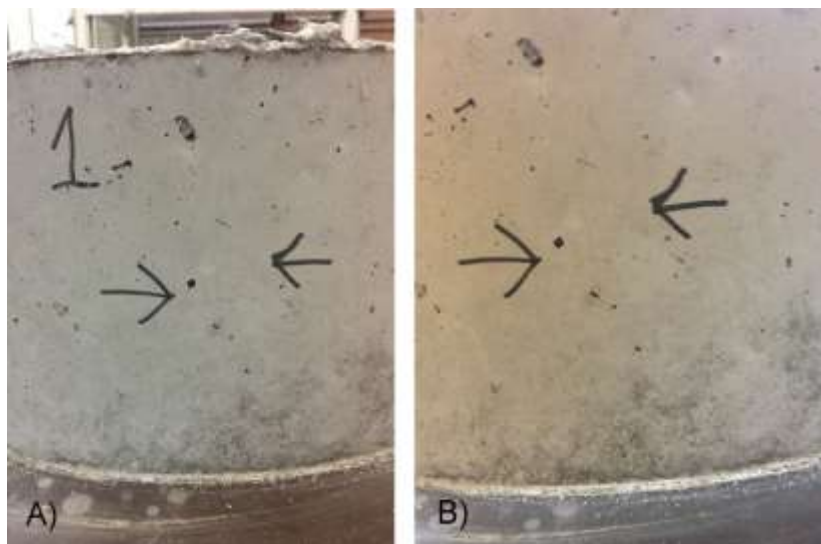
Fissuração da amostra CFN 03 do concreto reforçado com fibra de poliéster nova
